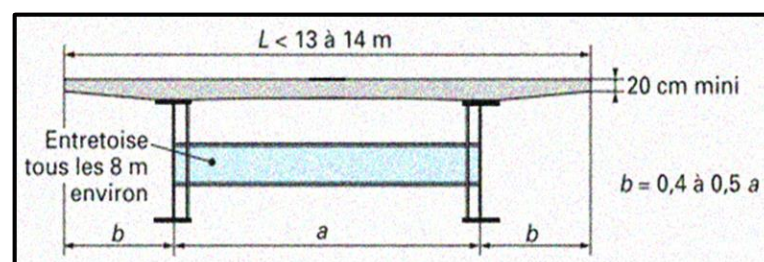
Coupe transversale d'un tablier bipoutres.
